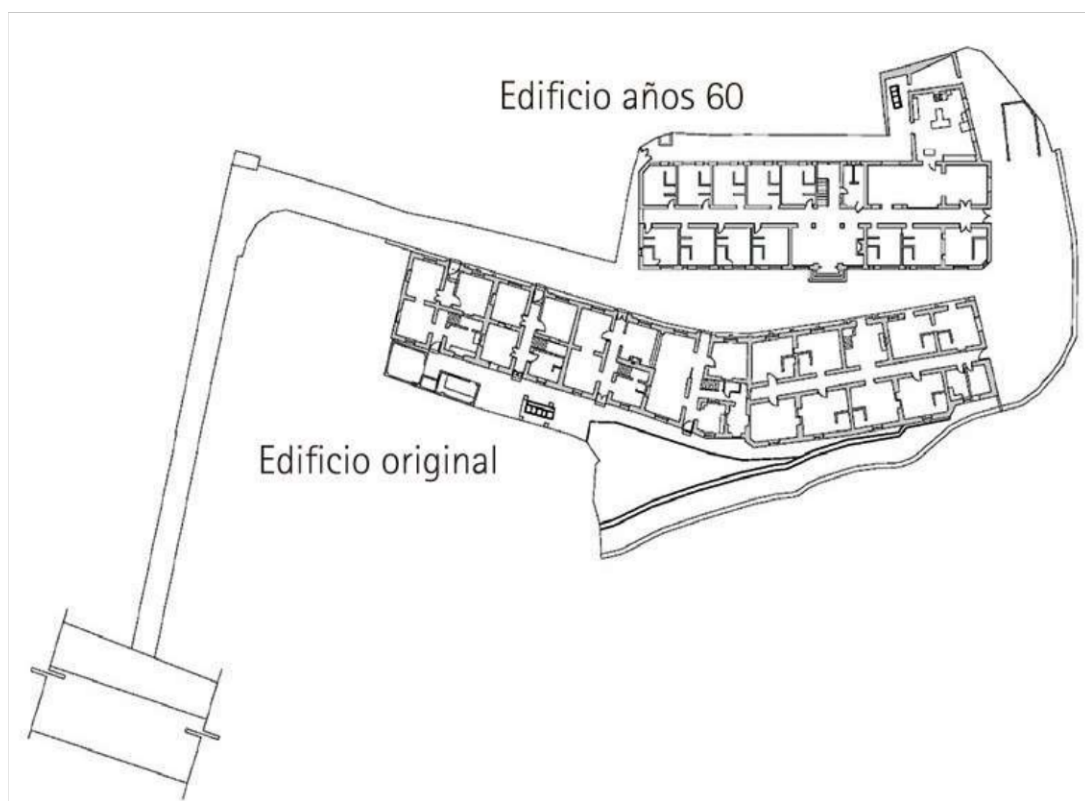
Disposición de piezas arquitectónicas en el predio // Fuente: (de Andalucía, 2015).
